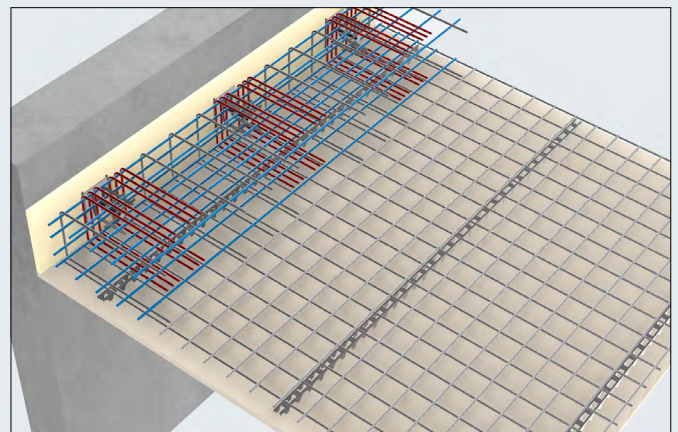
Restliche Zulagebewehrung je Dorn verlegen (Abstände beachten).
